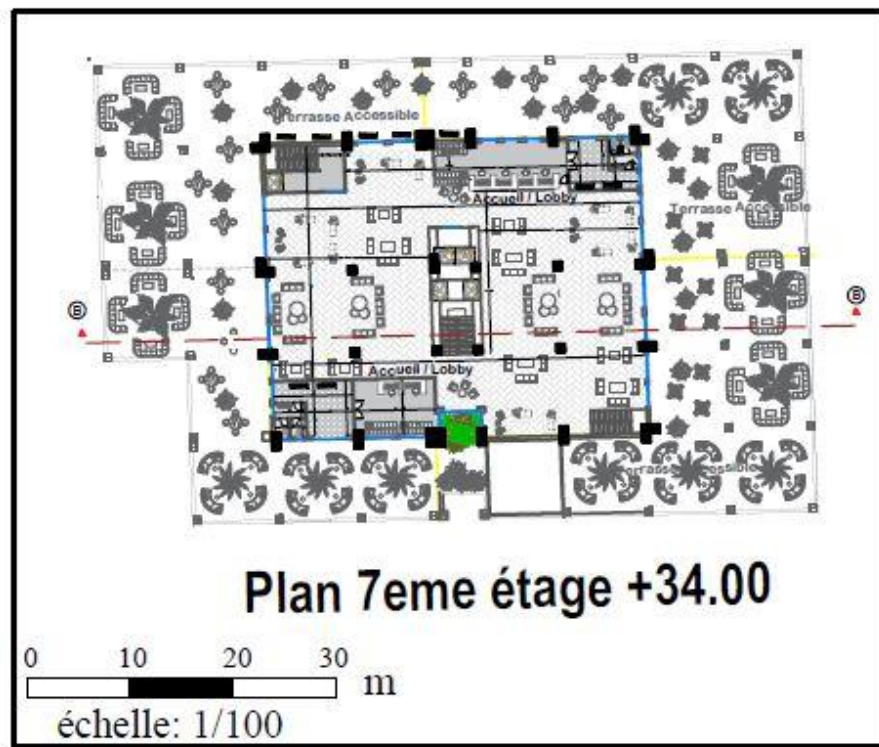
Plan de 7eme étage+34.00/Source : Traiter par l'auteur.
